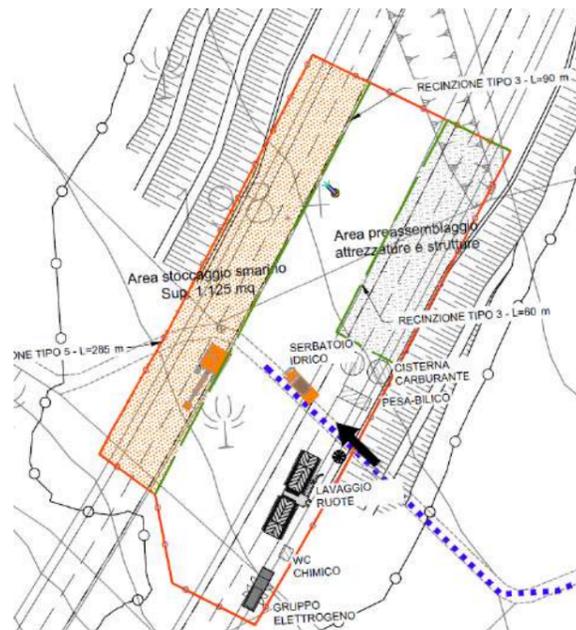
Planimetria del cantiere operativo CA.G.1C.
